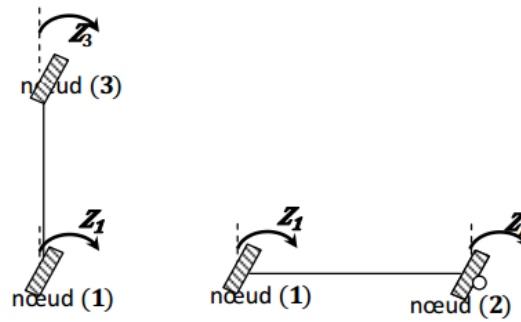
Portique de la figure 4.3. (Exemple : barre 1-2 et 1-3)
